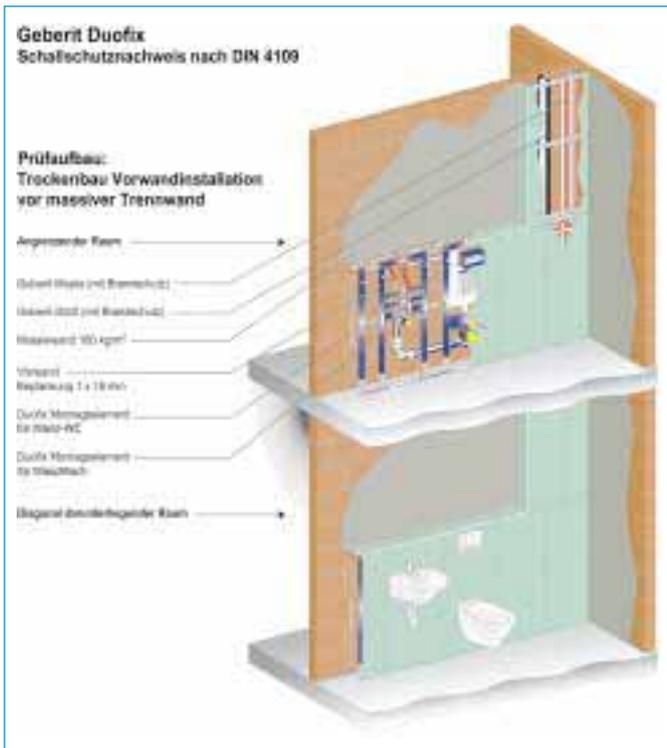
Trockenbau Vorwandinstallation mit Duofix
